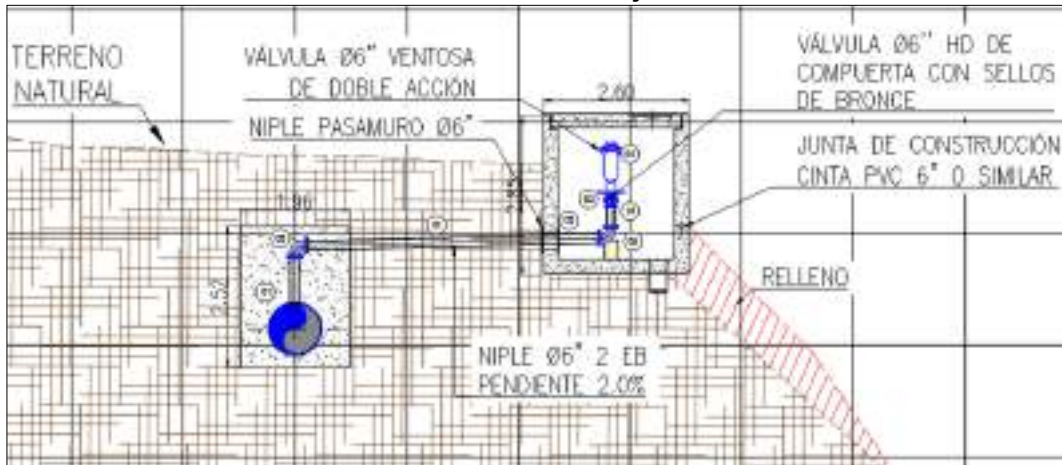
Alineamiento vertical – Detalle ubicación perfil caja ventosa de 6”
